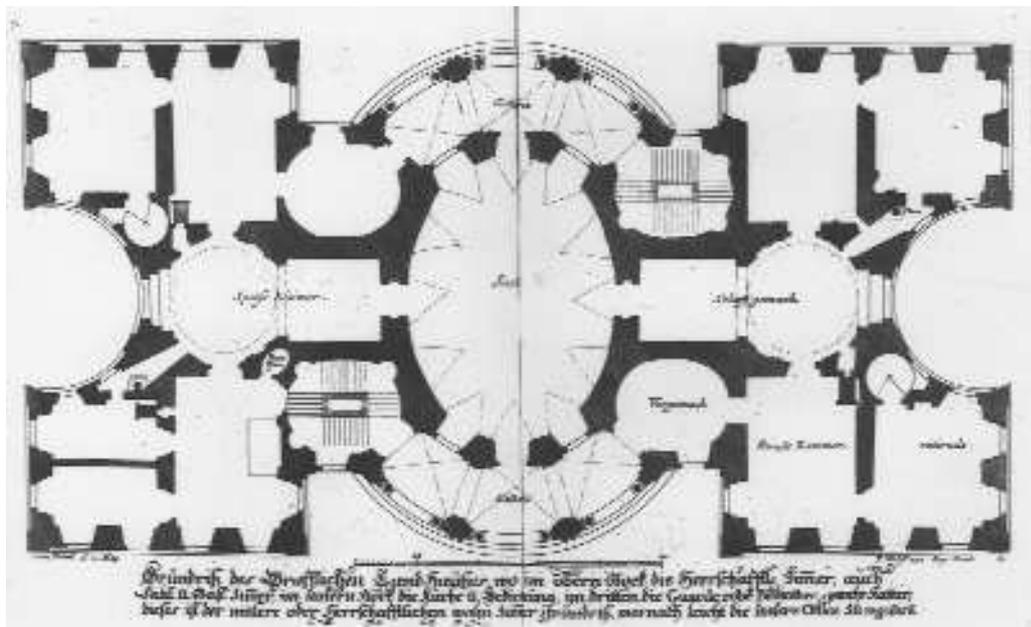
Nette, Gräfliches Landhaus, Grundriß des Mezzanin, um 1712
